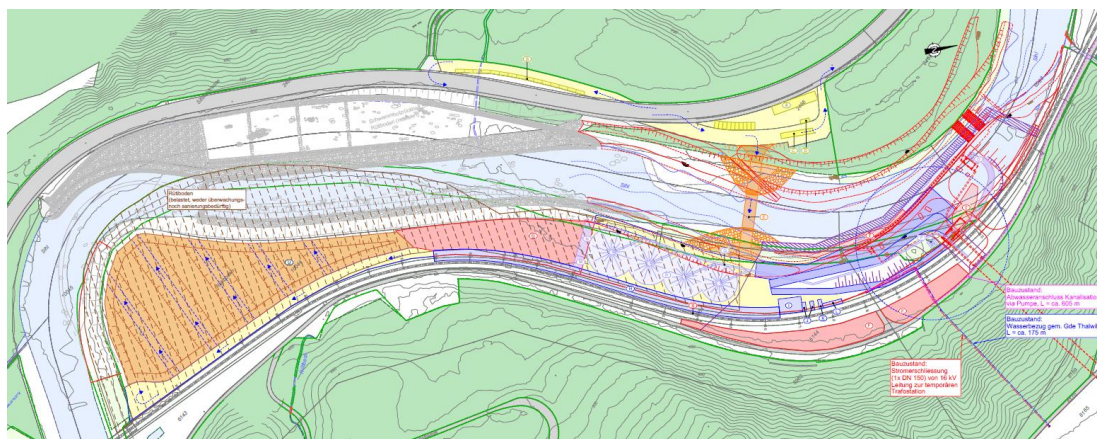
Planausschnitt «Einlaufbauwerk, Sihl Materialbewirtschaftung, Installation» Plan-Nr. 33-119
